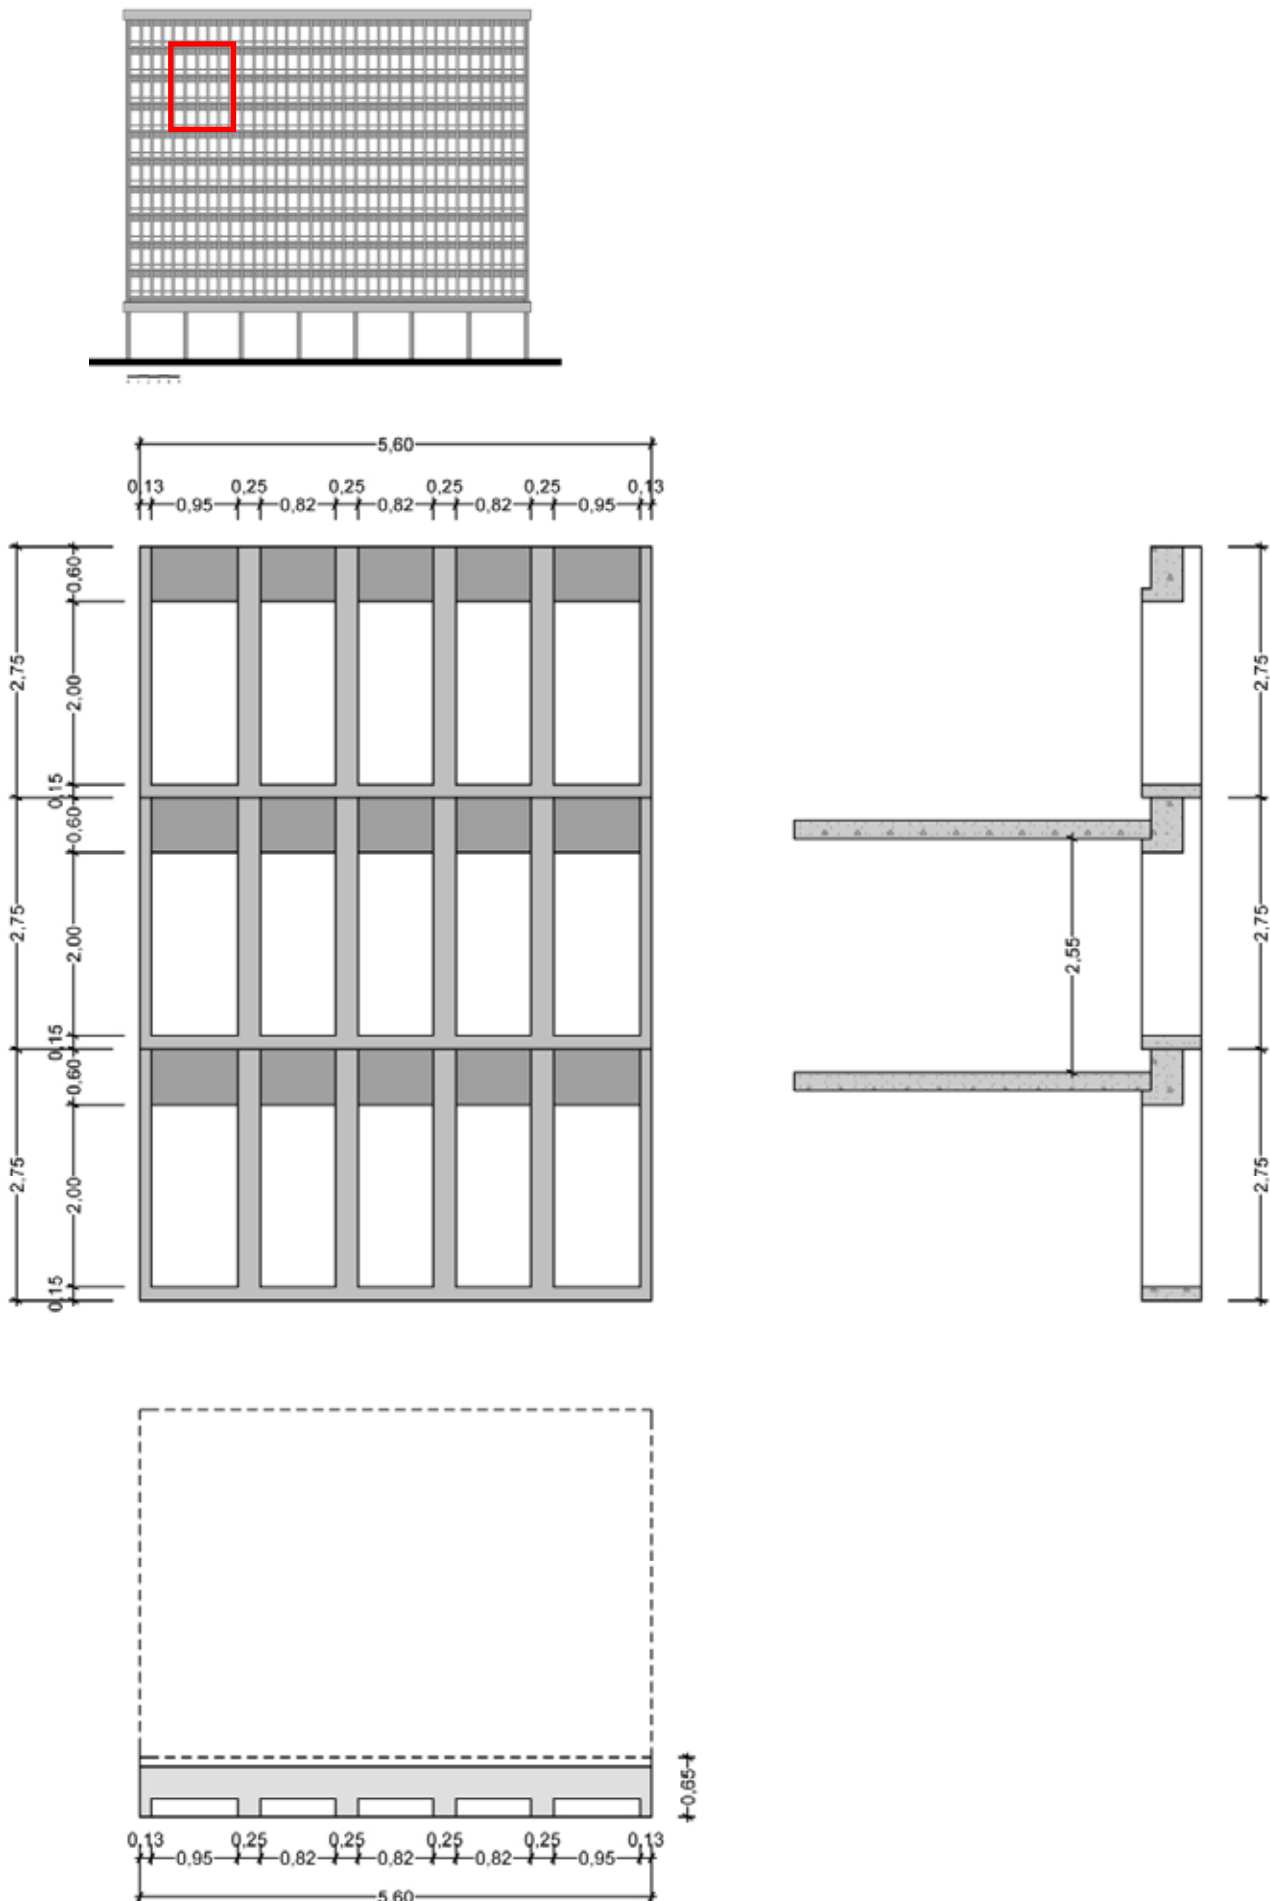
Detalles del fragmento de la fachada y la unión con la losa del forjado
